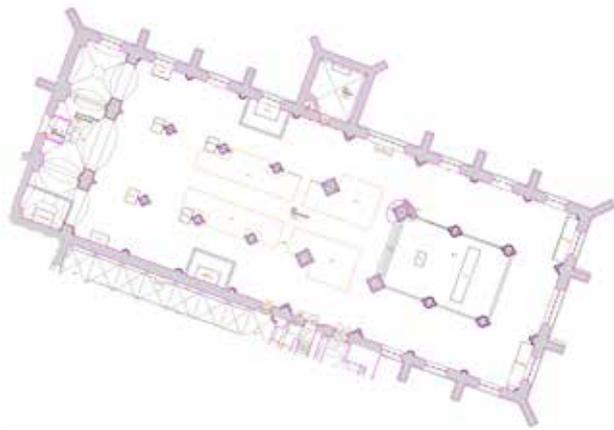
Münster Neuberg, geodätisch erfasster Grundriss (Aufnahme in einem lokalen System,²² Plan vom Verfasser genodet). – Für die weiteren Betrachtungen wurde der Plan auf Wände und Pfeiler reduziert und mit Begriffen versehen. Die Darstellung wurde für CAD²³ aufbereitet, sodass in ihr gemessen und konstruiert werden kann.
